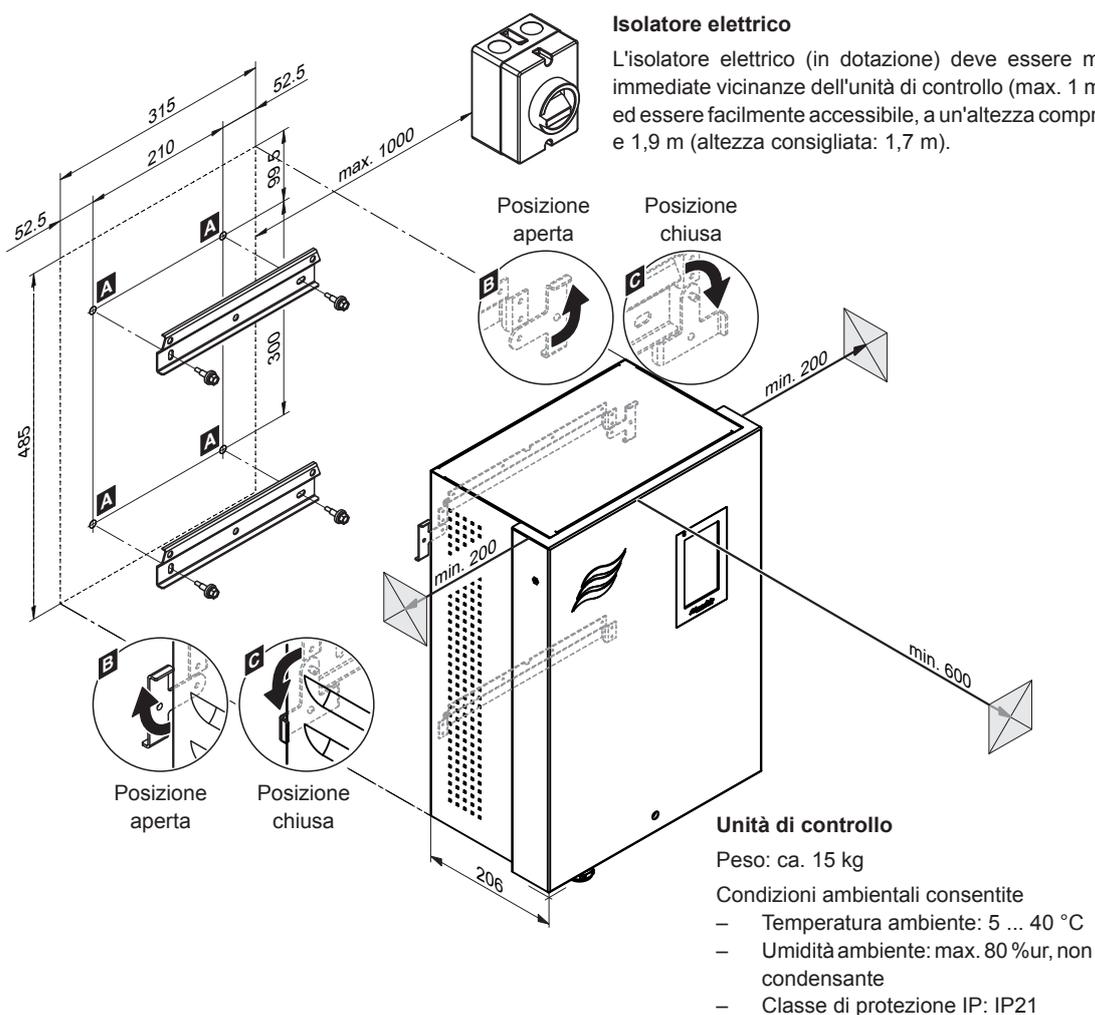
Montaggio dell'unità di controllo - dimensioni in mm
